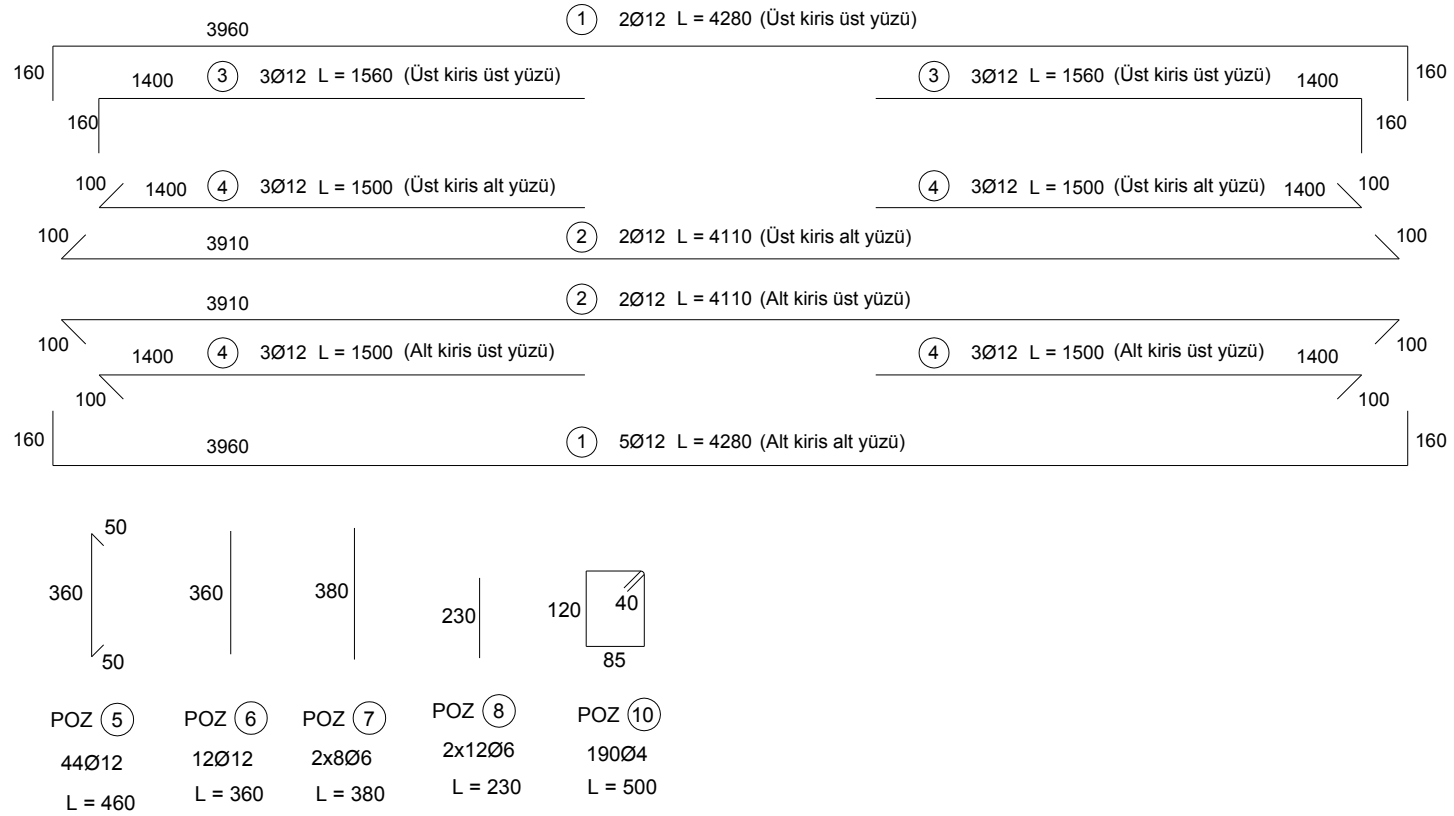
RRxcb kiriş donatı planı ve kesitleri
